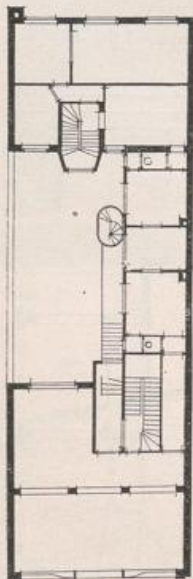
Schadowstrasse 47. Obergeschoss. 1:500.
